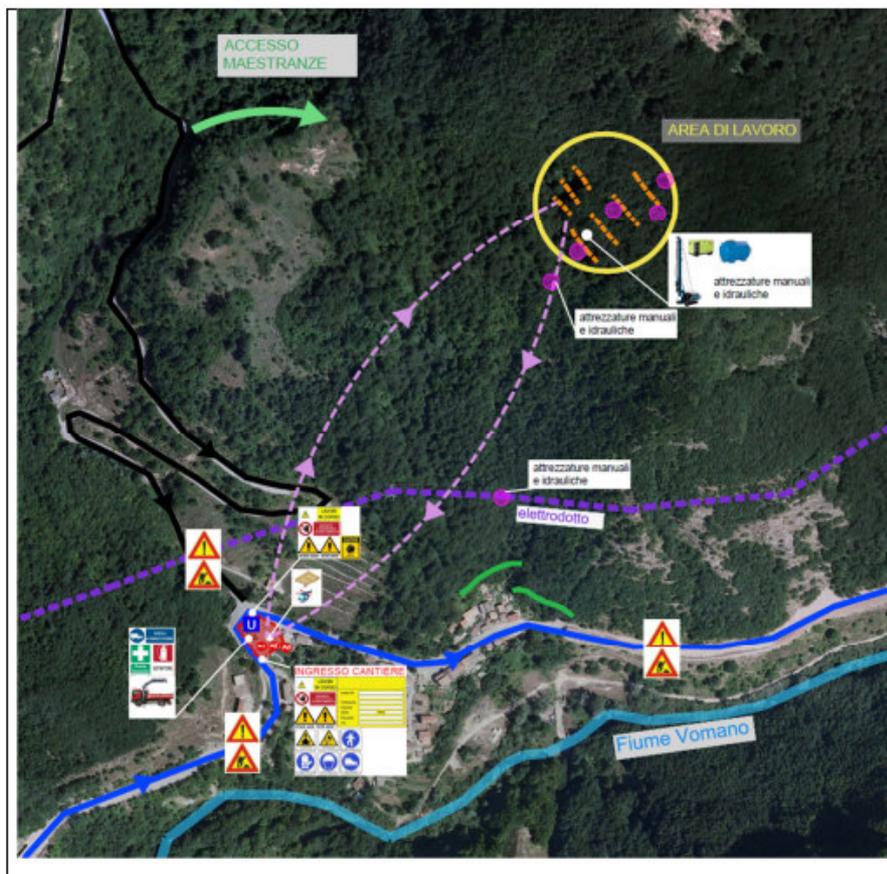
Cantierizzazione (estratto dall'Elaborato E5)
